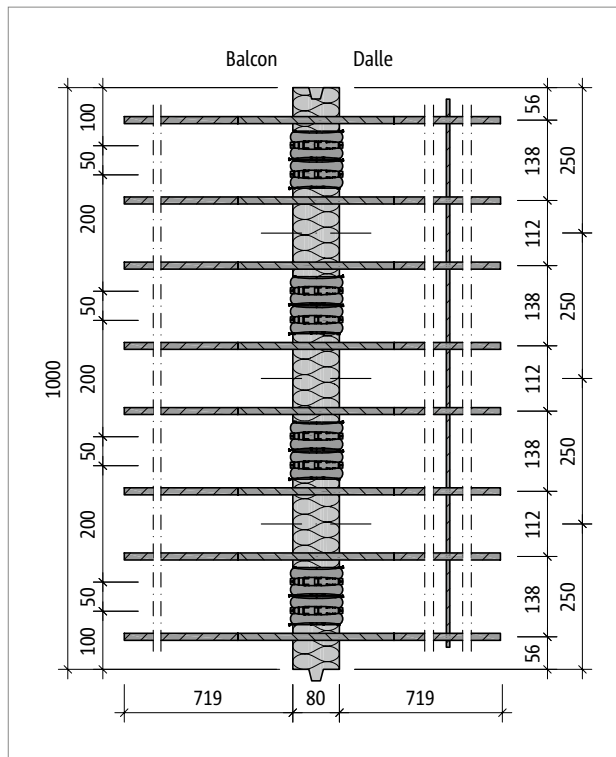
Schöck Isokorb® T type Q-E-V6 : plan de base du produit
